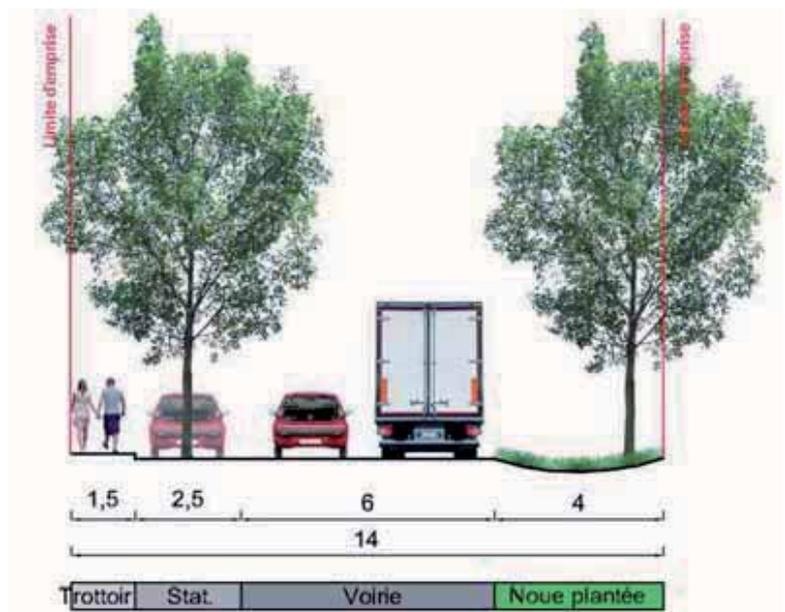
Profil type des voies tertiaires : profil 3 : avec stationnement
